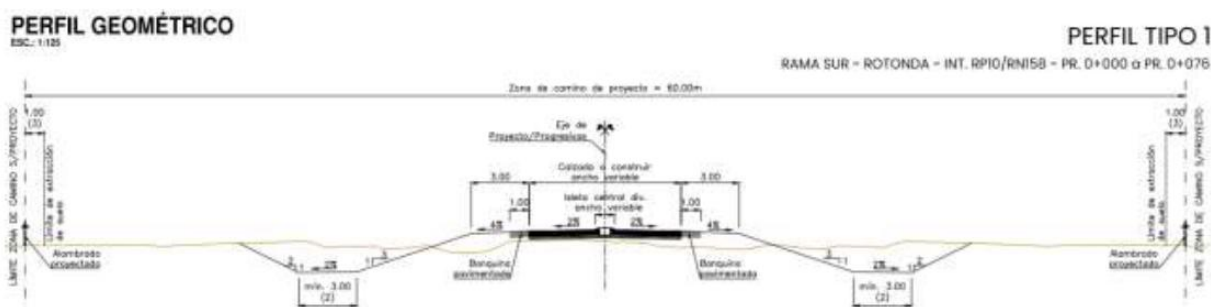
Perfil Tipo 1 – Rama Sur – Pr. 0+000 a 0+076
